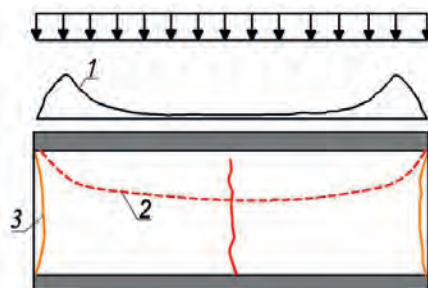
Горизонтальные растягивающие напряжения σ_x , касательные напряжения τ по шву между кладкой и плитой перекрытия ϵ_s [5]: 1 – эпюра касательных напряжений; 2 – эпюра горизонтальных растягивающих напряжений; 3 – деформации усадки
